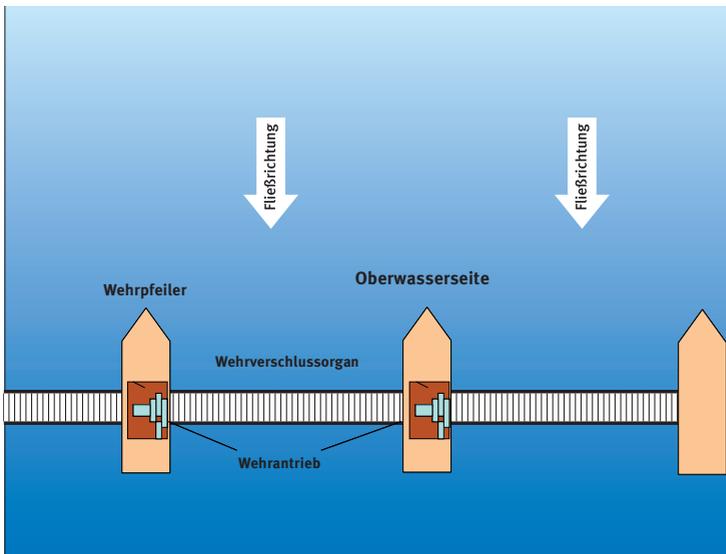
Beispielskizze einer Wehranlage (Draufsicht)
